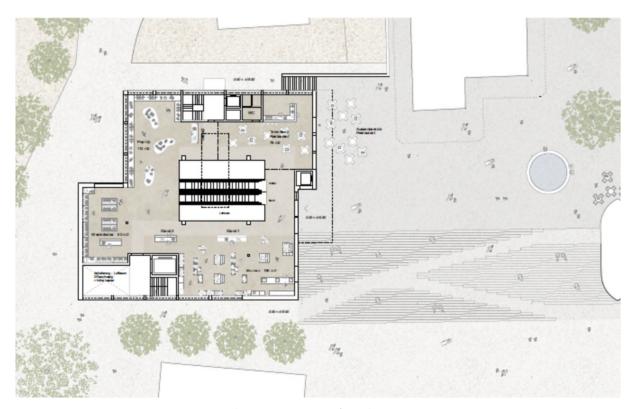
Grundriss oberes Erdgeschoss (Ebene oberer Dorfplatz).
